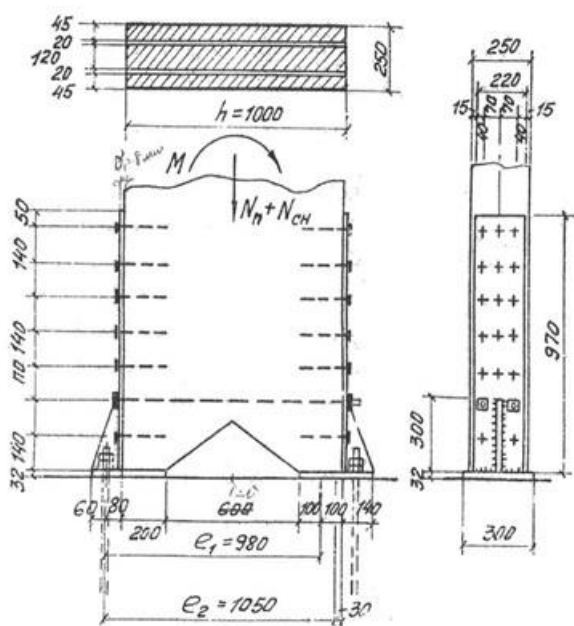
Анкерное крепление колонны к фундаменту [2]
